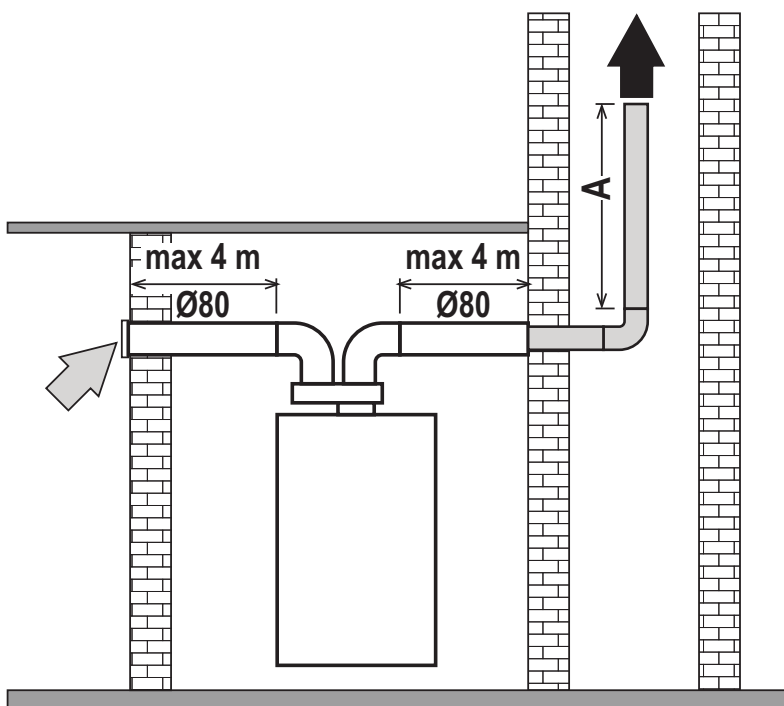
Schema nur Abgasführung mit flexiblem Rohr
